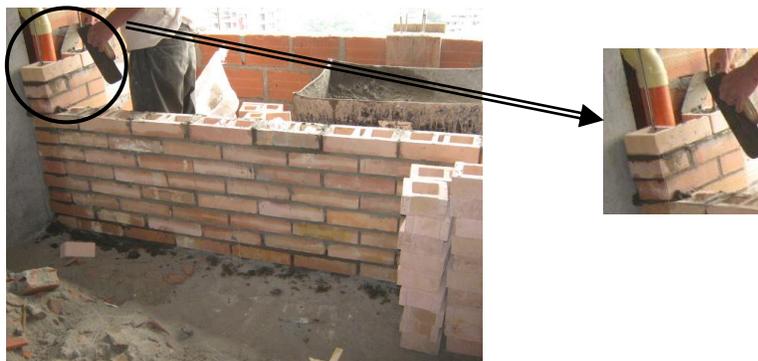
Revisión de tamaño de brecha en Mampostería en limpio y dovelas.
